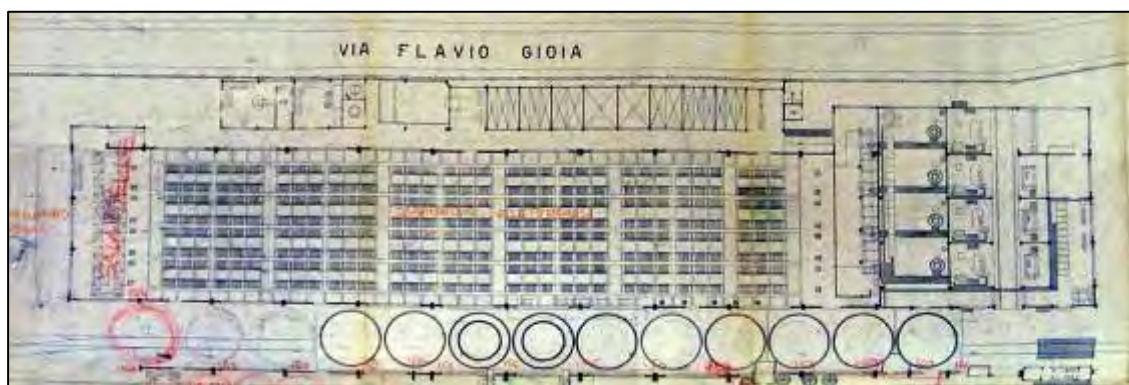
1944, planimetria sala celle elettrolitiche, estratto dalla pianta generale dello stabilimento "Montevécchio", scala 1:250 (fonte: archivio Sacaim)
